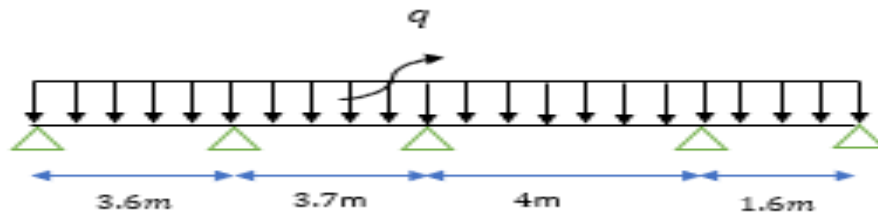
Schéma statique de la poutrelle appuyée sur 5 appuis.
